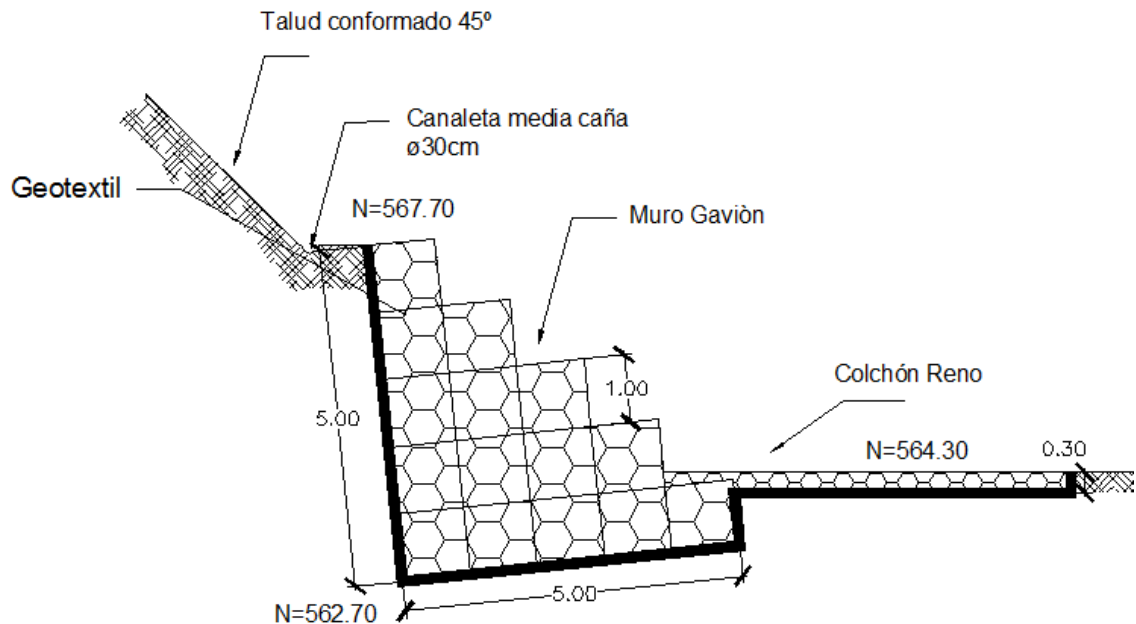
Detalle del muro gaviòn, propuesto en la Alternativa de Soluciòn N°2, sin escala.
